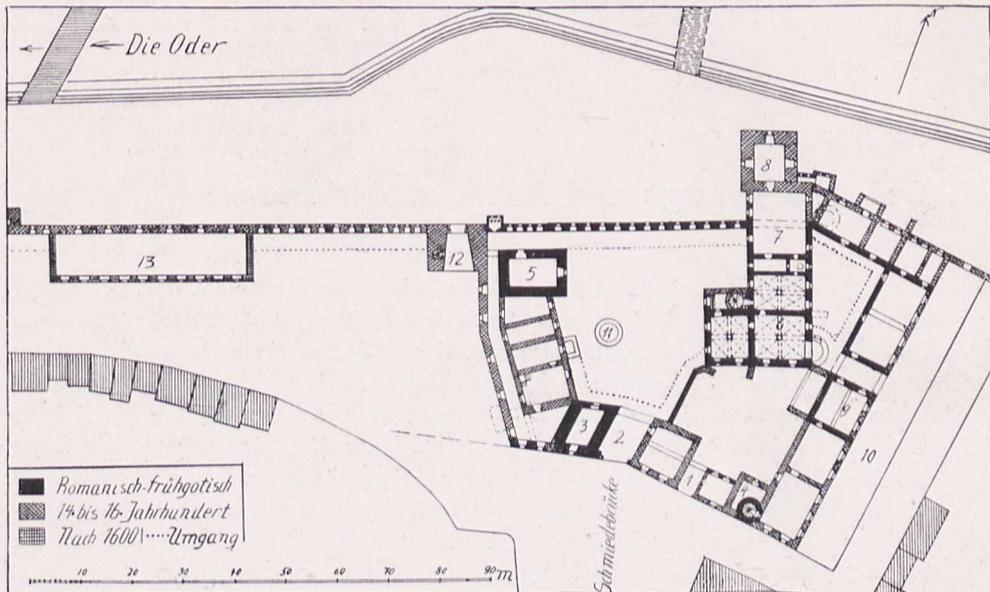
Rekonstruierter Grundriß der Kaiserburg.
